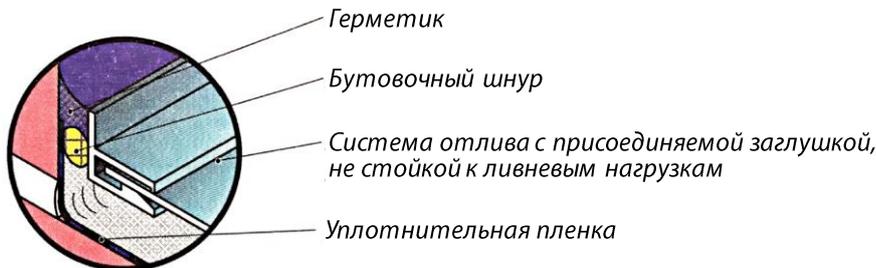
Боковое примыкание отлива к многослойной наружной стене
